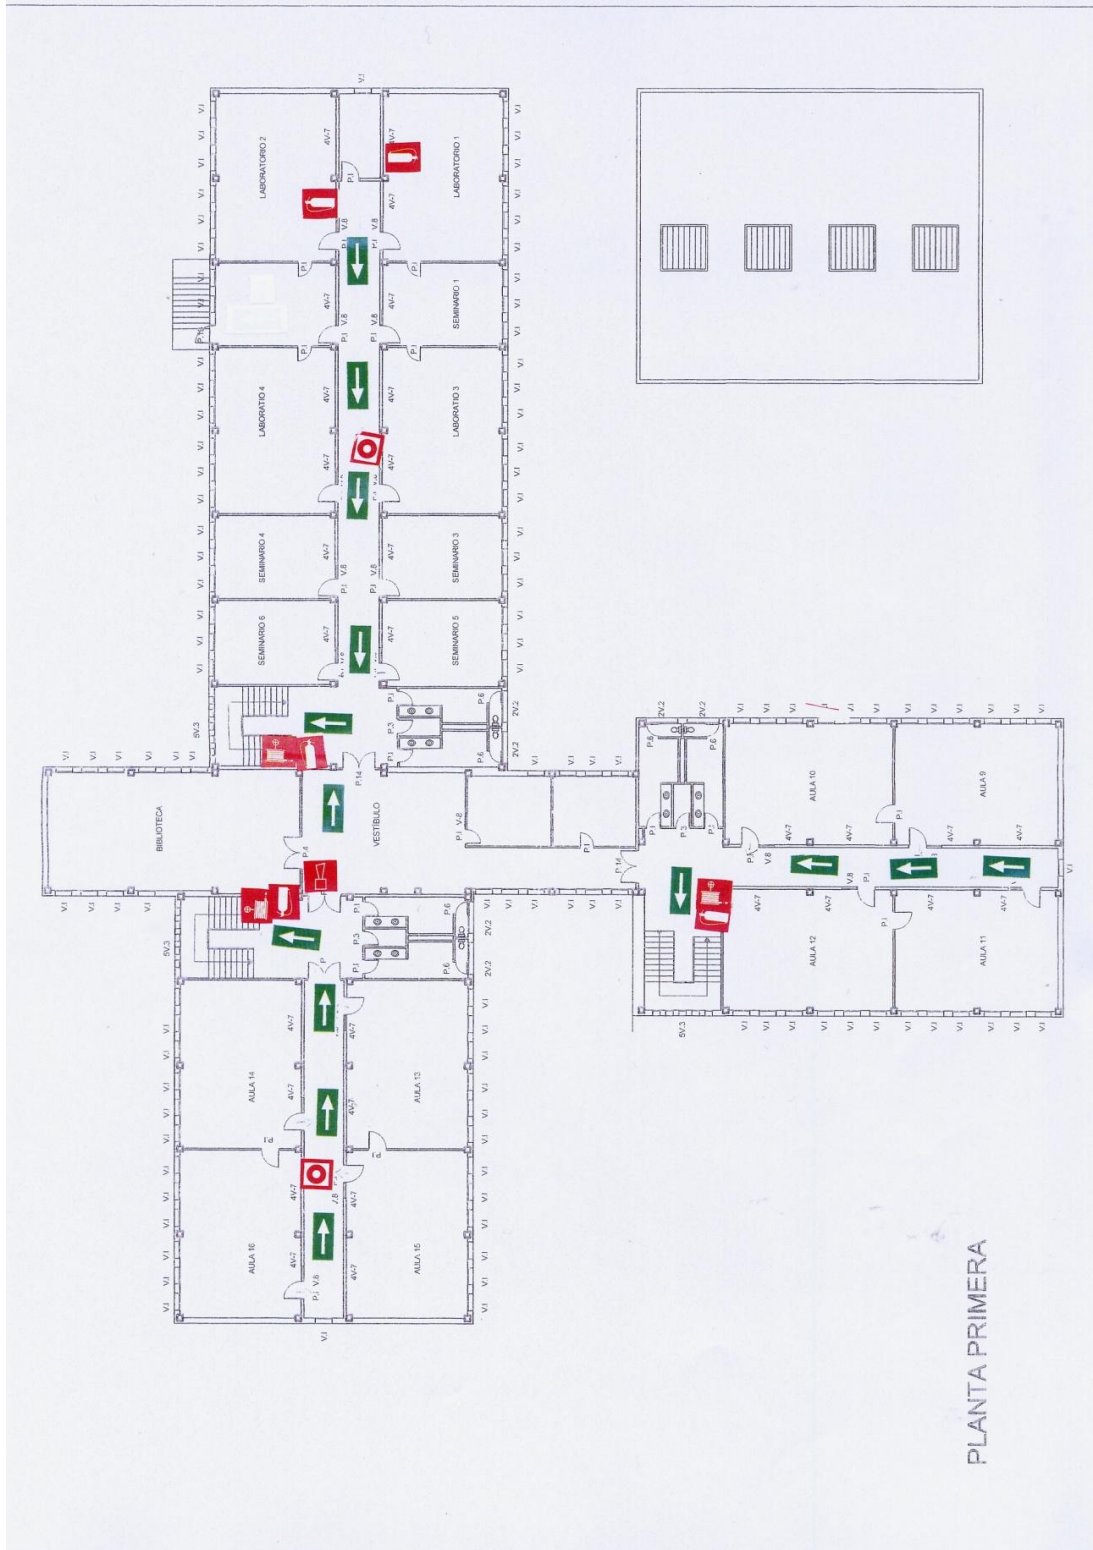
Plano evacuación planta primera. Fuente: I.E.S Cesar Manrique.
